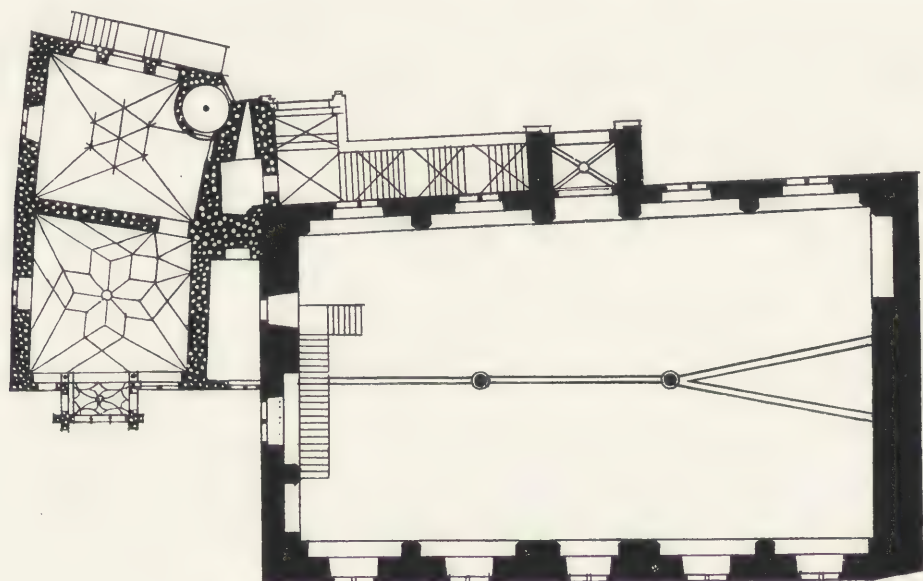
Ratshaus zu Koblenz. Grundriß im Erdgeschosß.
